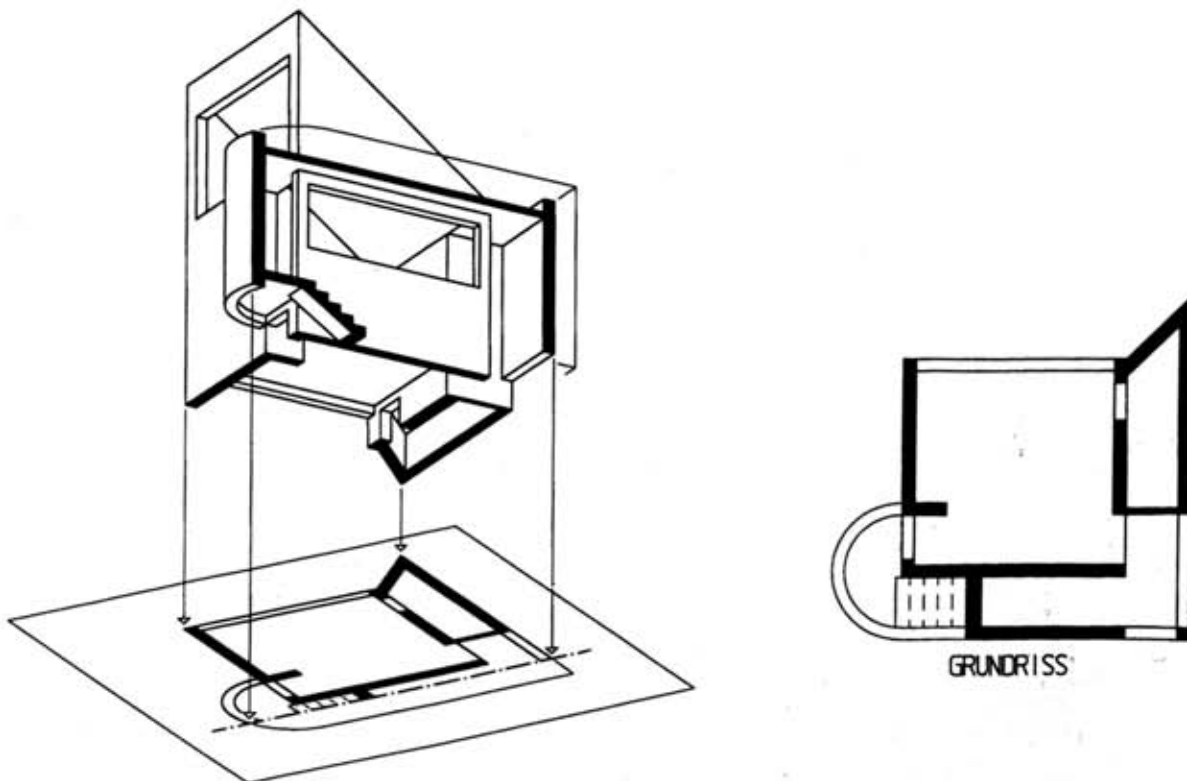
Grundriß Typ B (Abbildungsprinzip)
